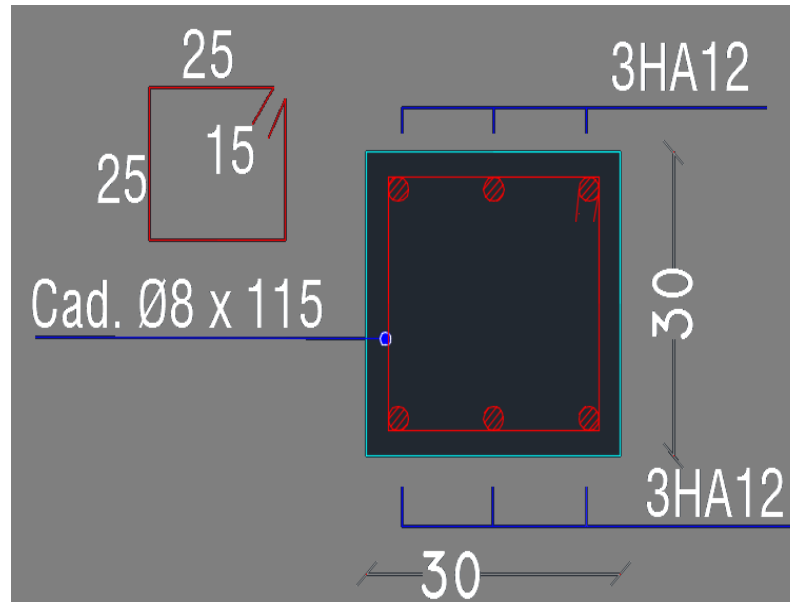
coupe de ferrailage des longrines aux niveaux d'appuis et travée
